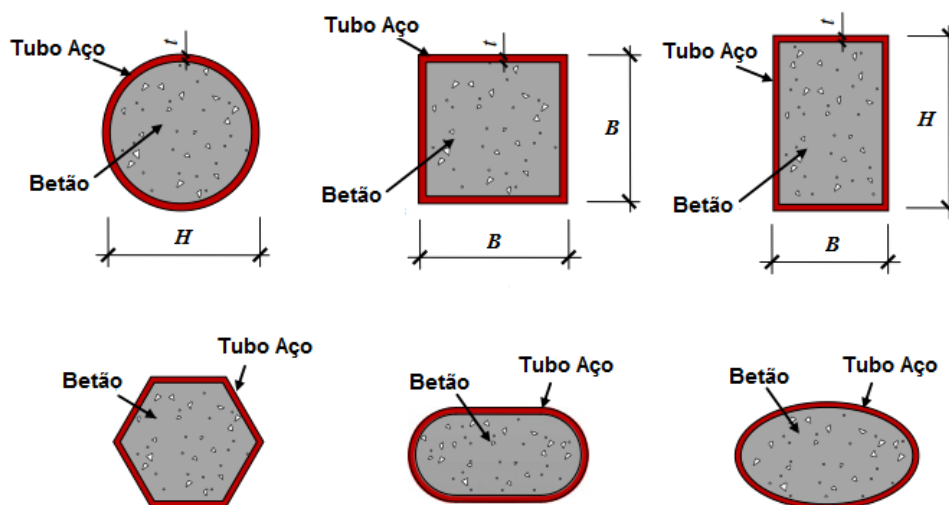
Secções normalmente usadas em colunas tubulares mistas de aço e betão
